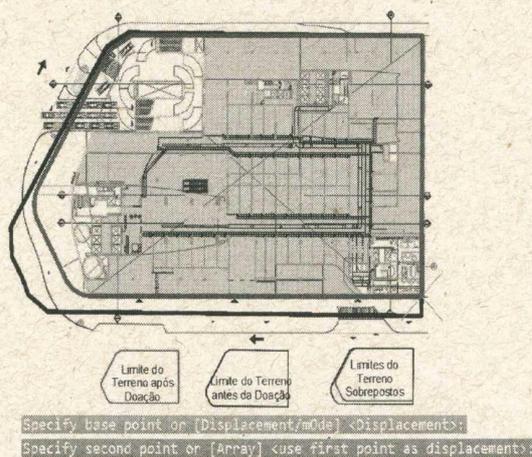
Planta Baixa do Térreo 1º Mall – esquemática, sem escala.
